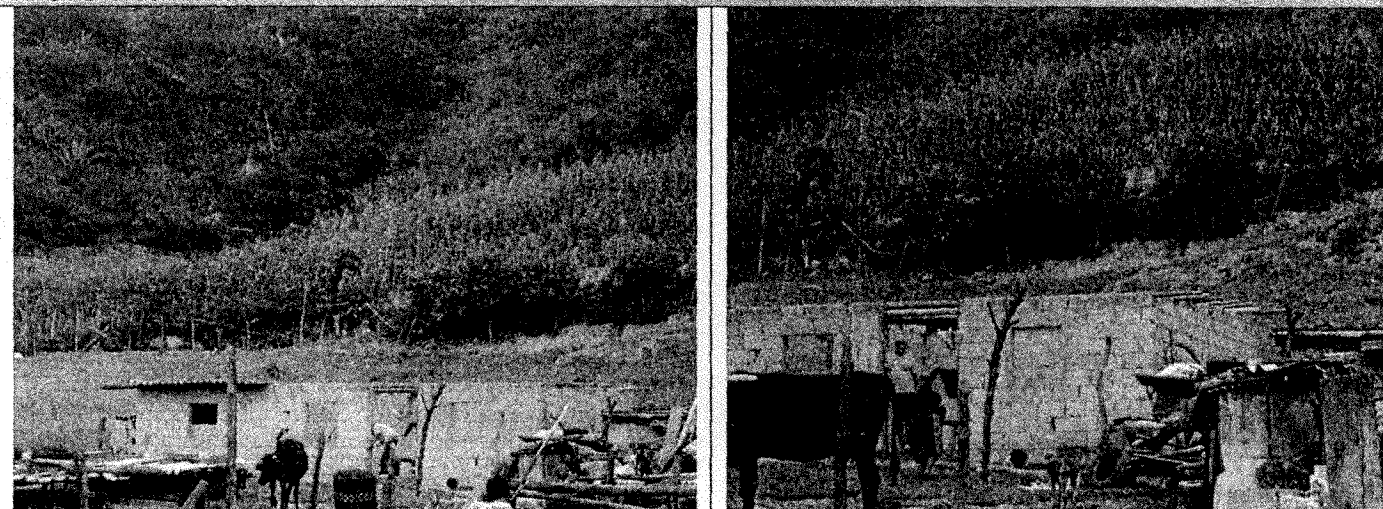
; Vista de proceso constructivo en el predio N° 1212603
